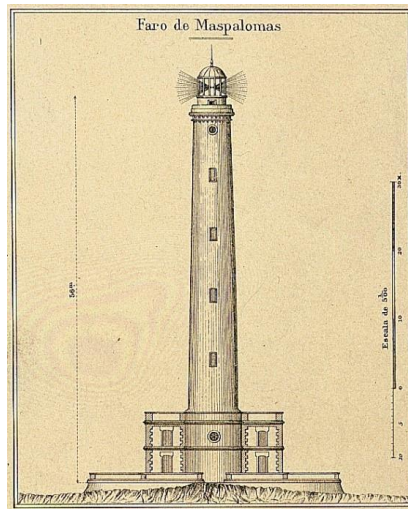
Alzado del Faro 1985. Fuente: Archivo histórico Cabildo de Gran Canaria.
